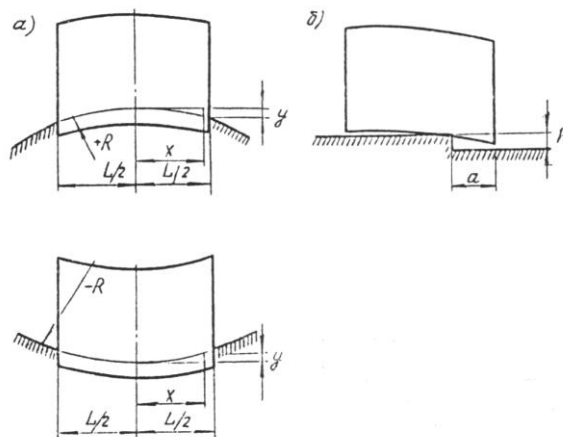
Схемы вертикальных перемещений земной поверхности при подработке, вызванных кривизной (в) или образованием уступа (б)
